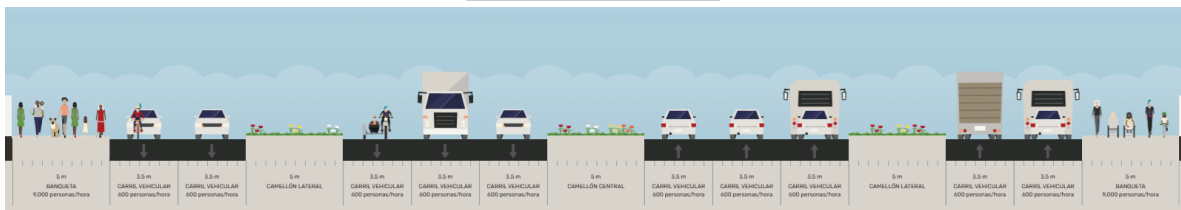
Sección Av. Guillermo Prieto Lujan. Fuente: PDU2040
